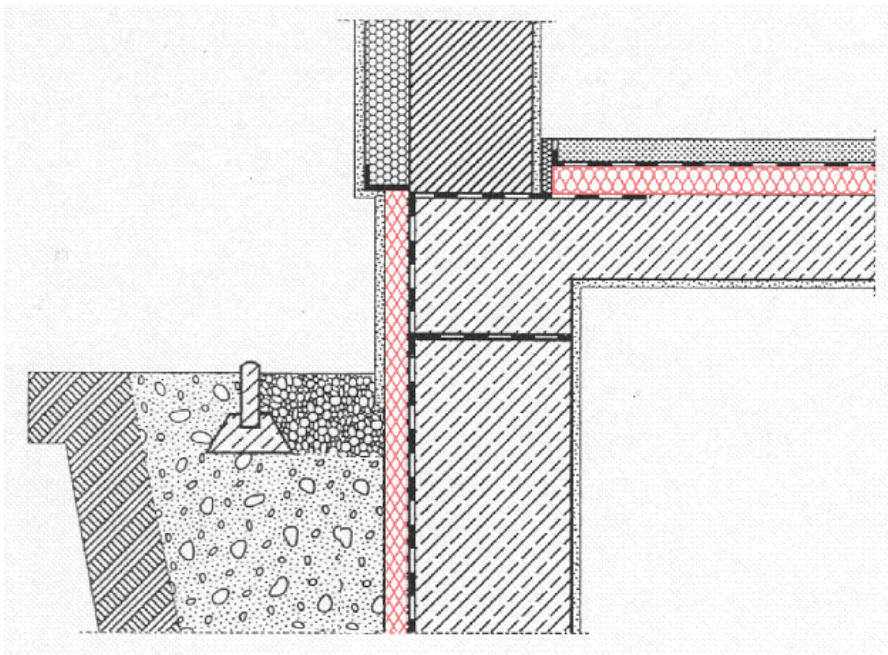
Sockelbereich, wärmebrückenfreier Anschluss der Perimeterdämmung an das wärmedämmende Mauerwerk oder an das außenliegende Wärmedämmverbundsystem.
